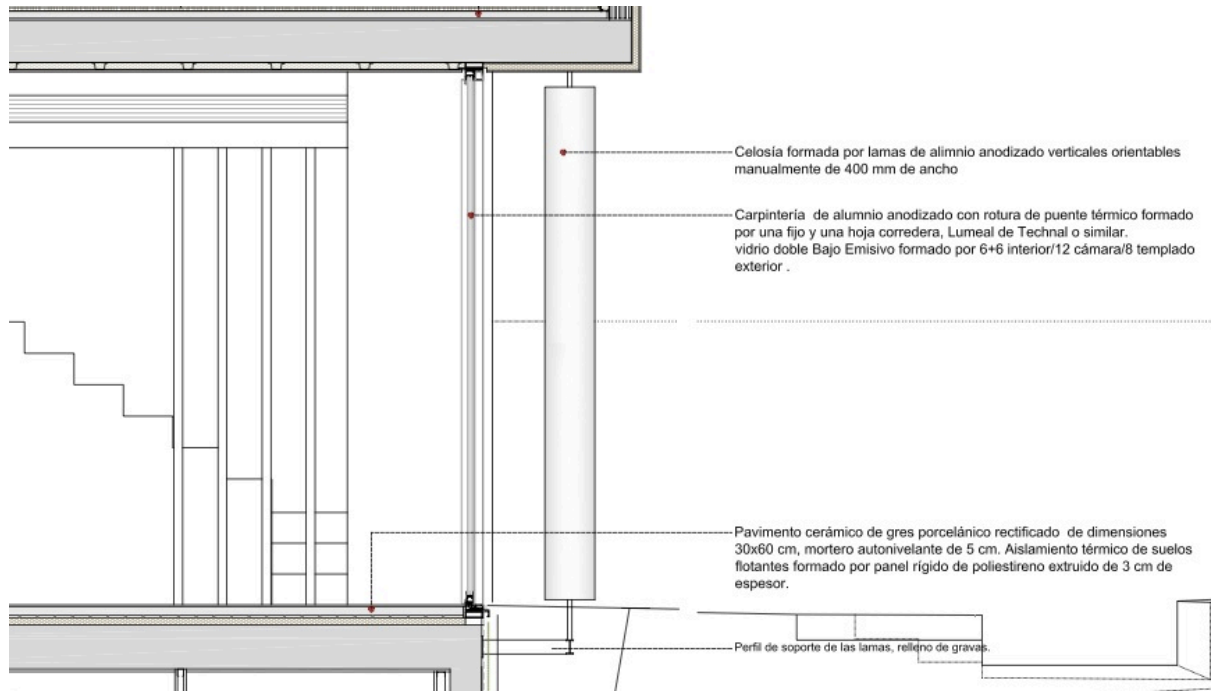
Detalle de la sección de la perfilaría de lamas orientables
